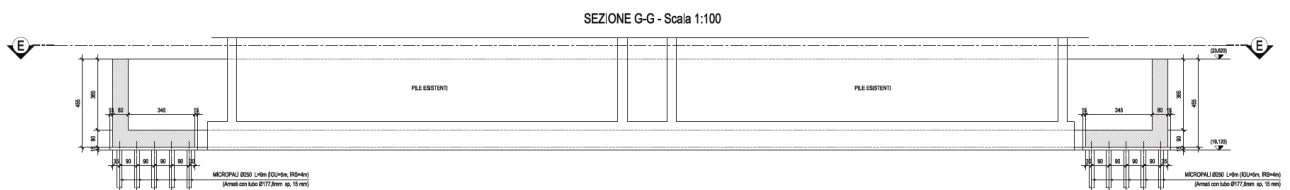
Opere di protezione CVF Autostrada A14 - Prospetto del muro in c.a.
